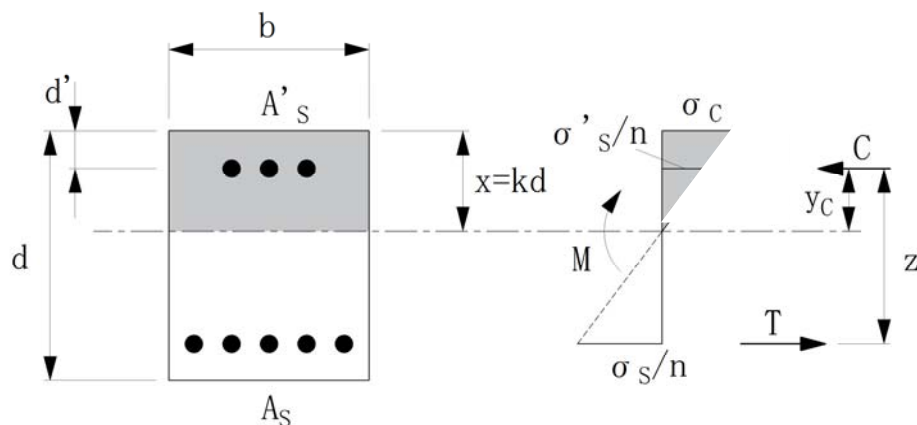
2軸複鉄筋断面の鉄筋コンクリート断面
